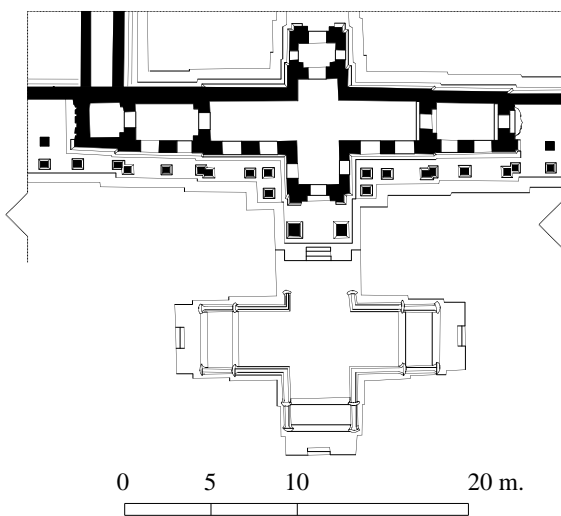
Plan du pavillon d'entrée Sud de la troisième enceinte de Ta Prohm
